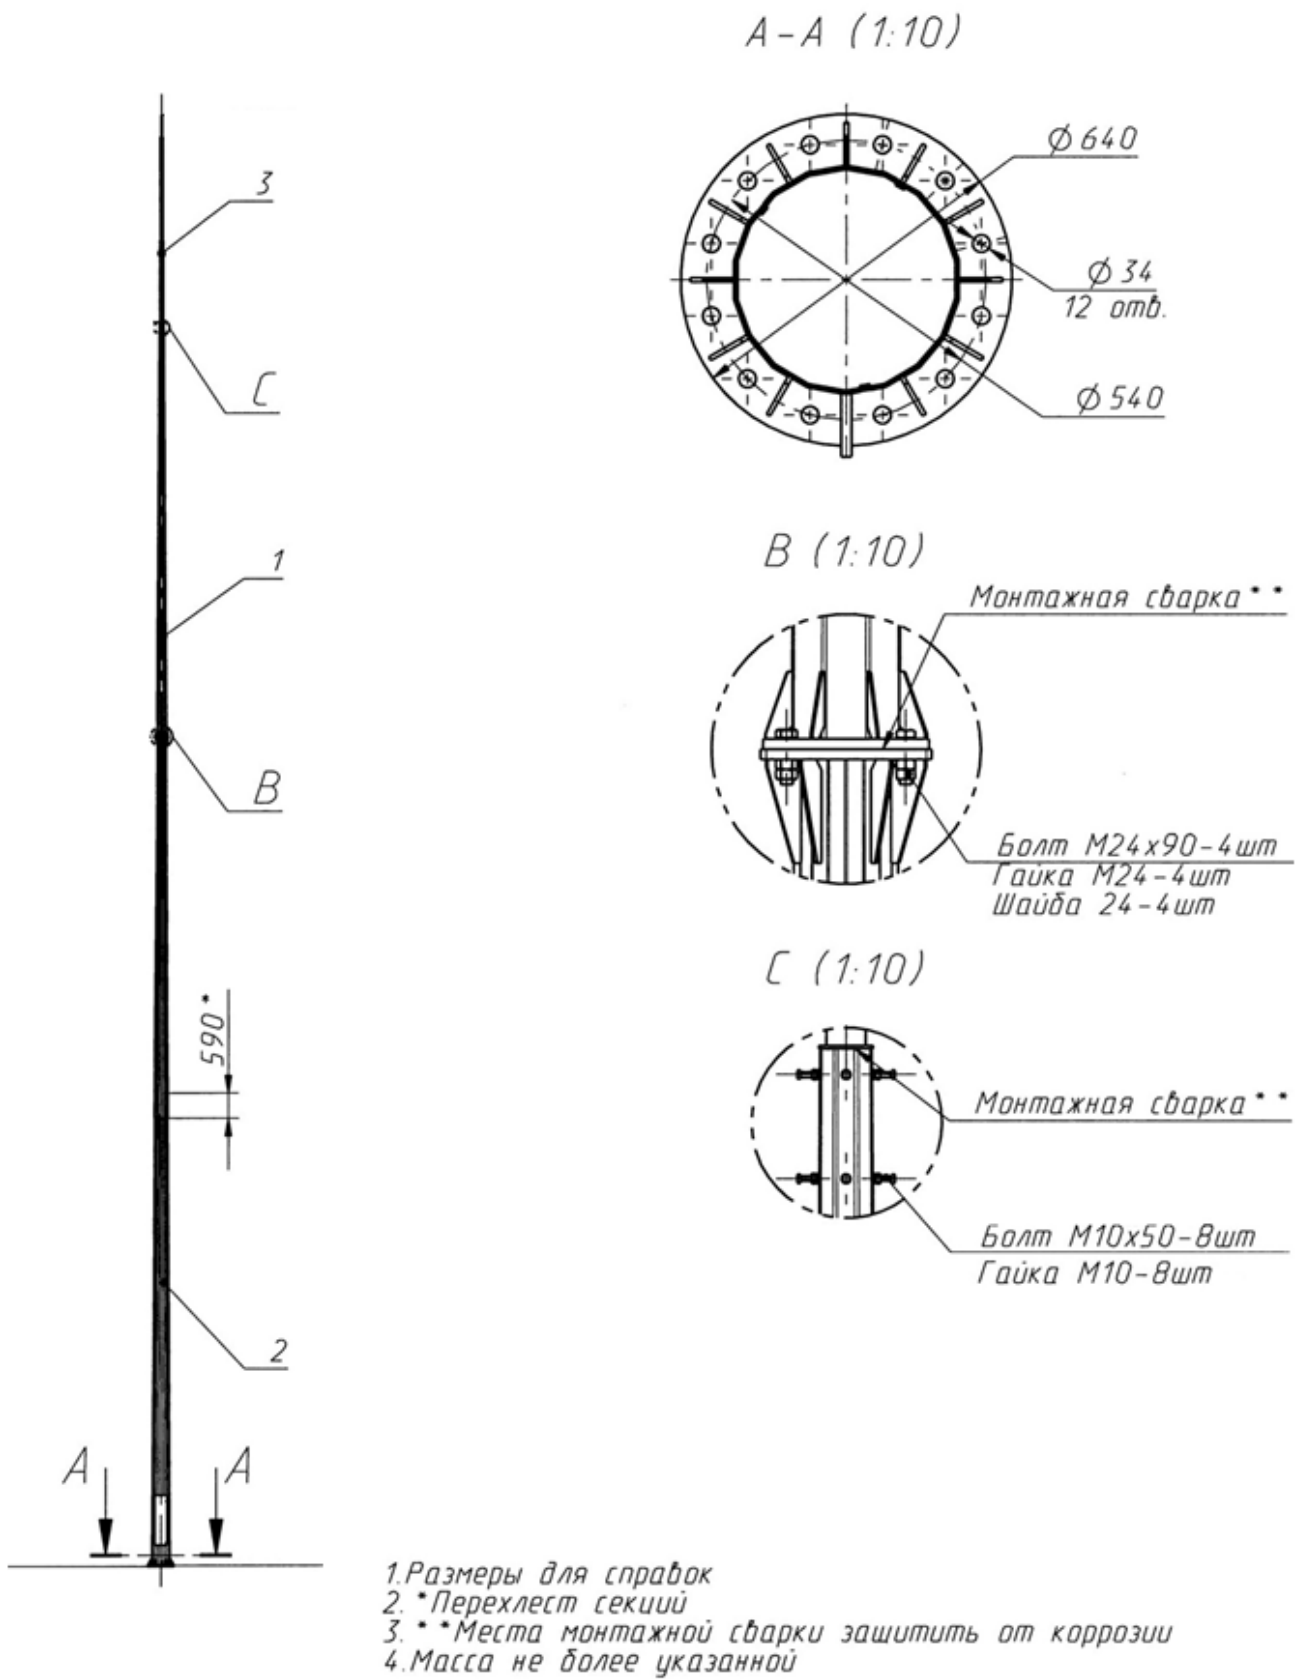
Общий вид мачты молниезащиты и монтажный чертеж
